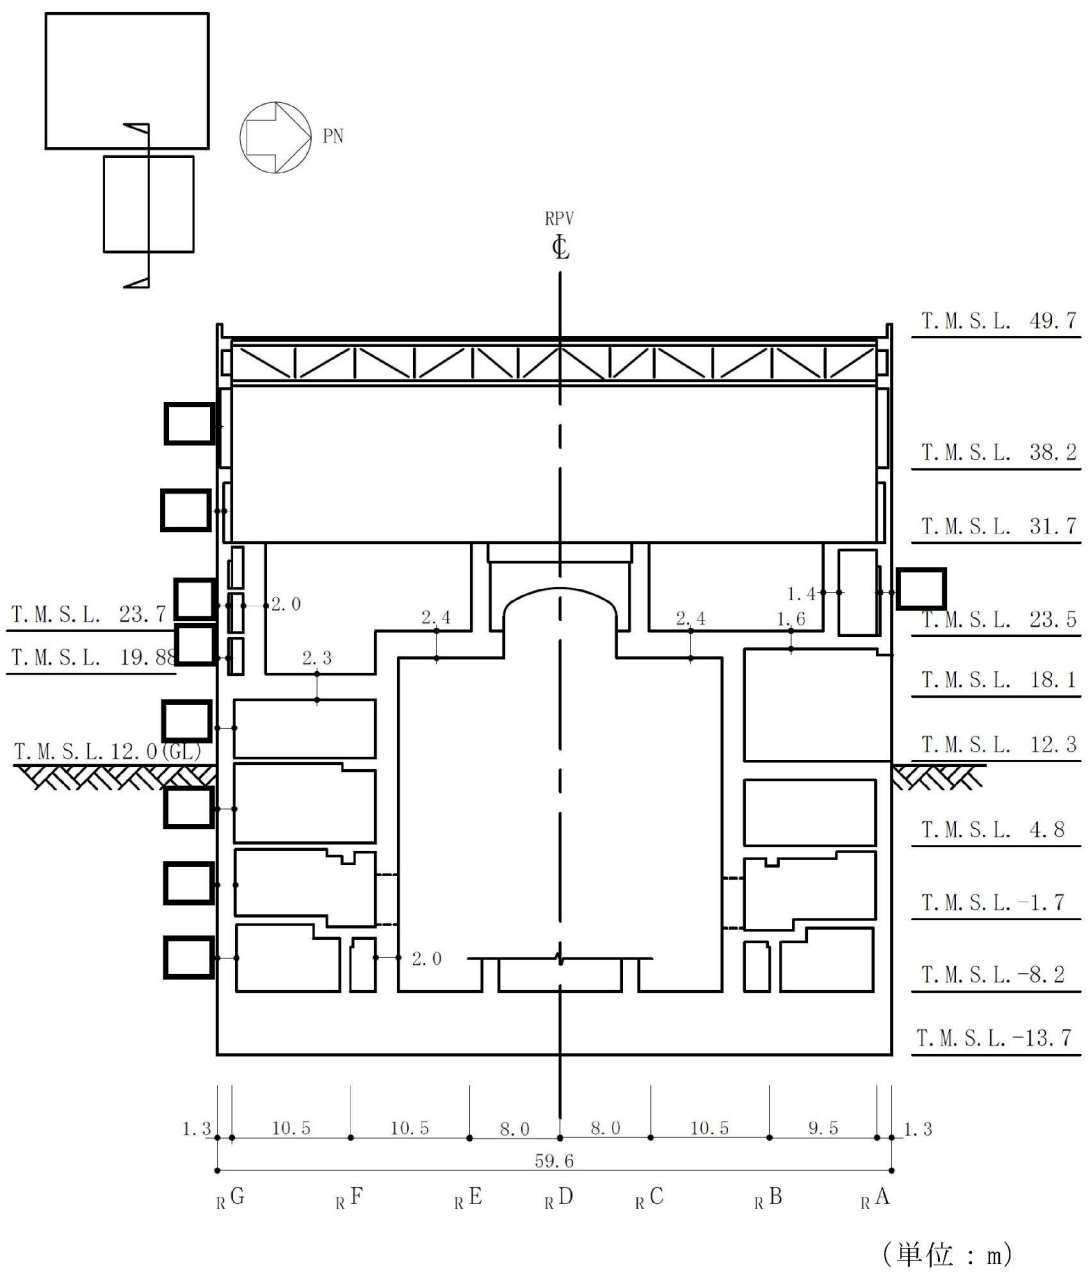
原子炉建屋の概略断面図 (EW 方向) (2/2)
